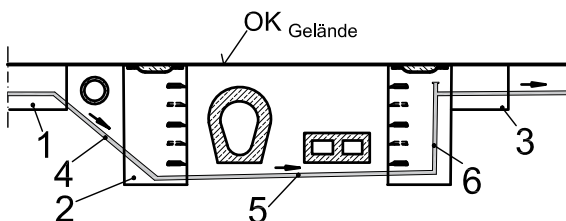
Mischform Dükeräste schräg-senkrecht (Prinzipskizze)
